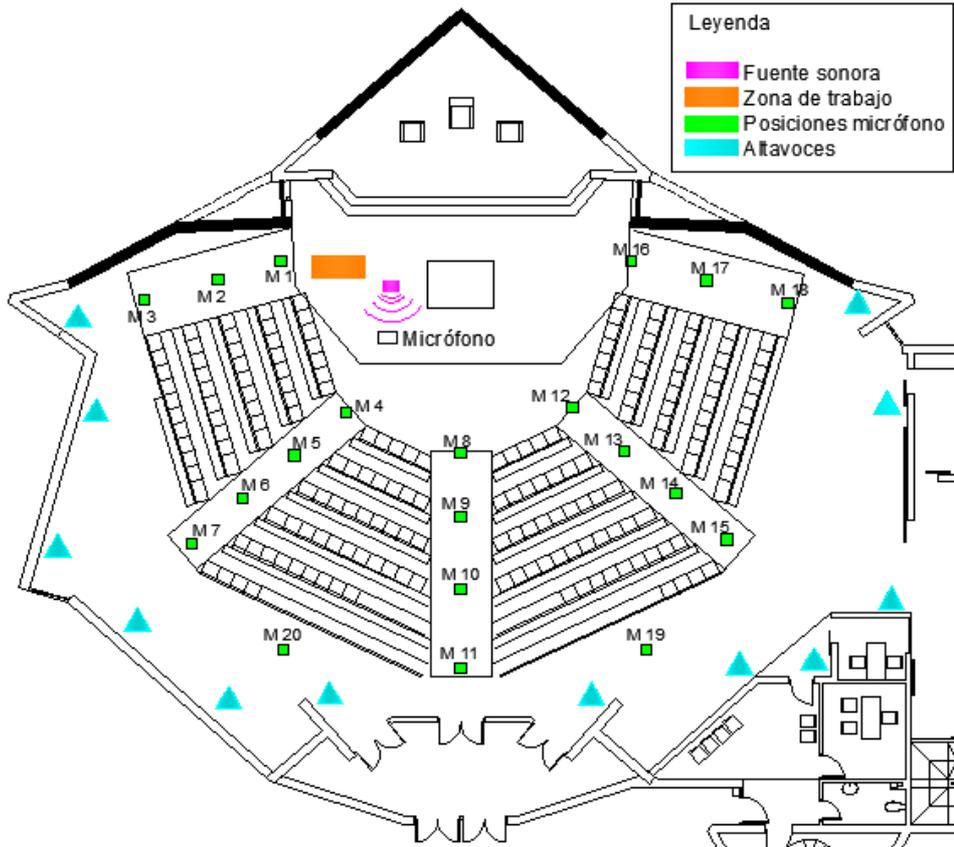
Planta disposición fuente sonora y muestras, caso 2.
